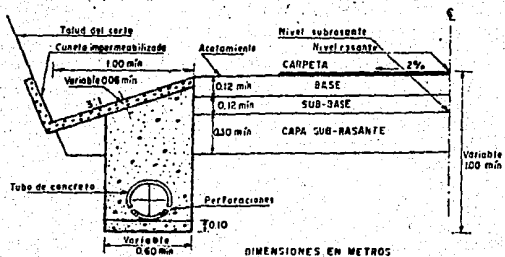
Sección transversal de un solideo longitudinal de cuneta, según la práctica mexicana. (Secretaría de Obras Públicas.)
